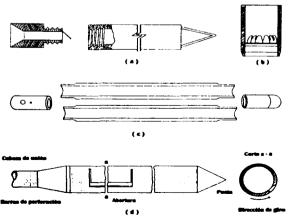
DISPOSITIVO PARA EL SONDEO POR LAVADO.
